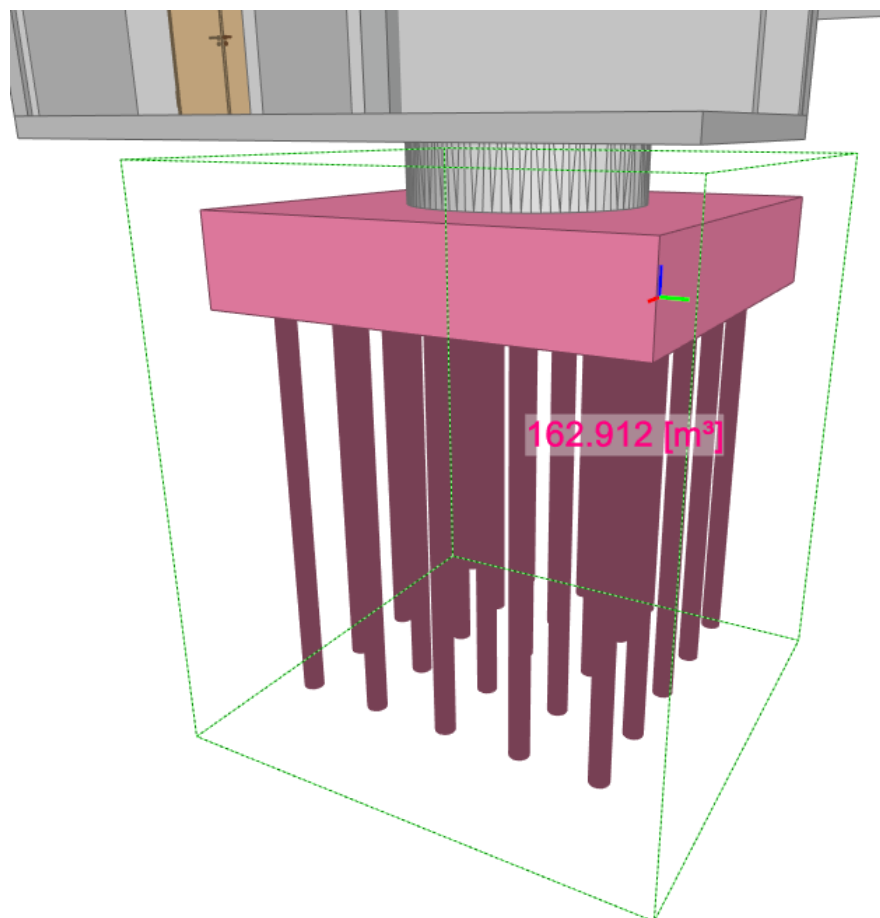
Cálculo del volumen de la losa de pilotada en BIMvision
